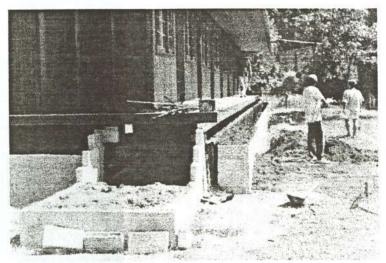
Murro de arrimo executado com compensado e blocos de concreto.
